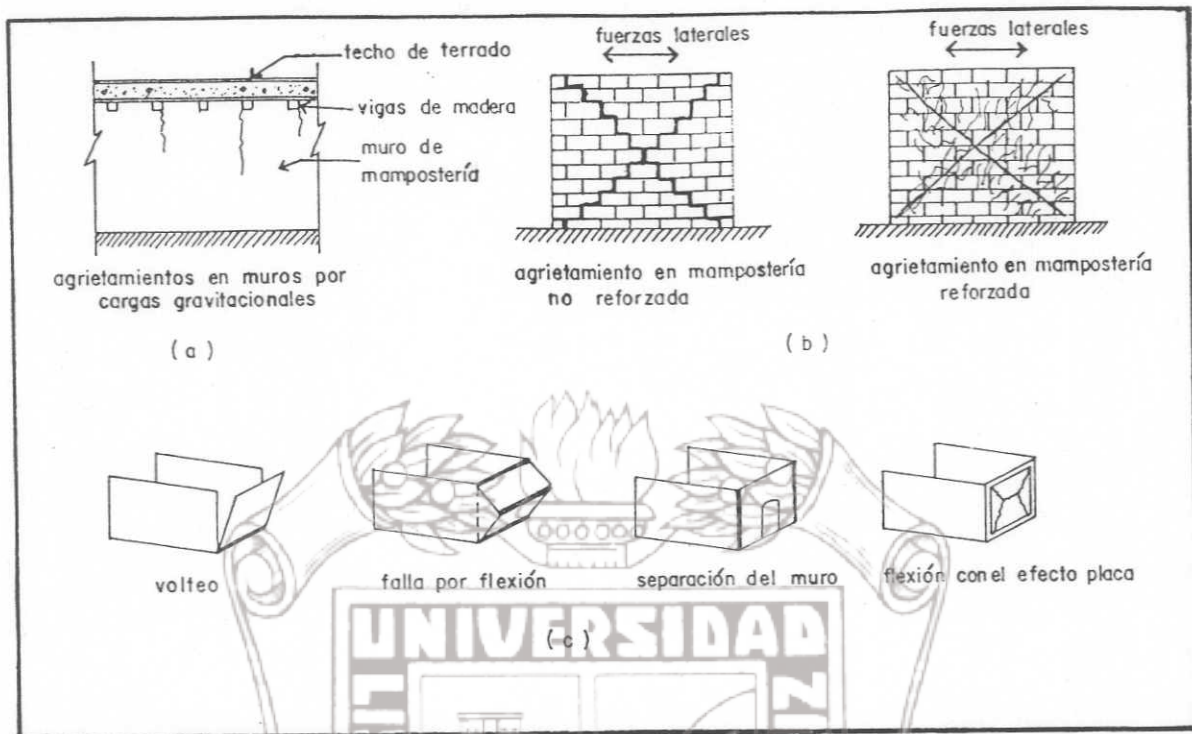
(a) Agrietamientos verticales en muros. (b) Grietas diagonales en muros reforzados y no reforzados debidos a cargas en su plano. (c) Mecanismos de falla de muros bajo fuerzas perpendiculares a su plano.
